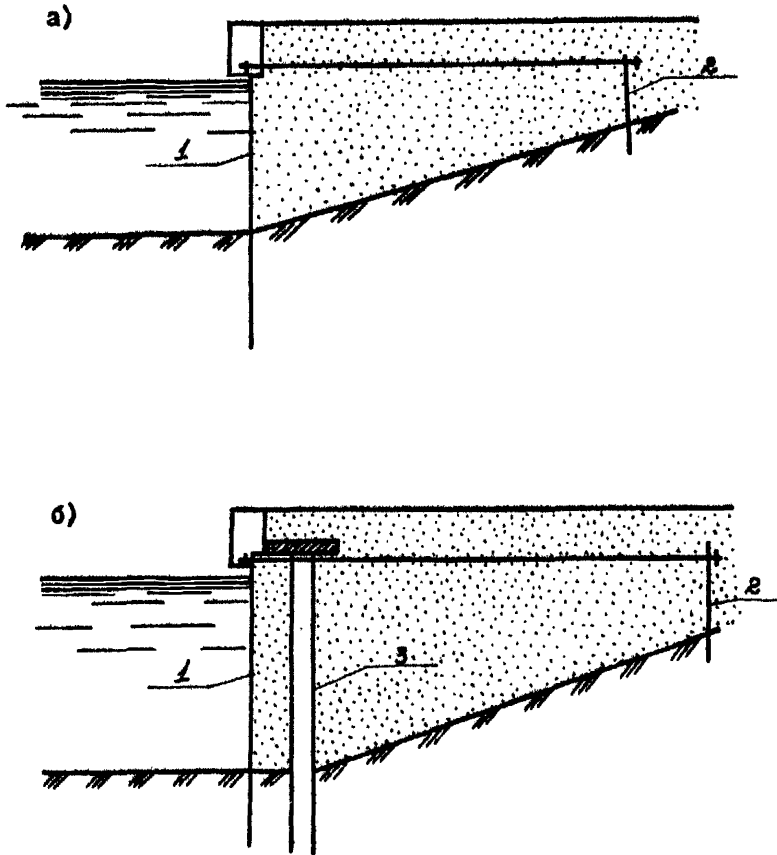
Конструкции бойверков: а – заанкеренный бойверк из металлического шпунта; б – экранированный бойверк; 1 – лицевая стенка; 2 – анкерная стенка; 3 – экранирующая стенка
